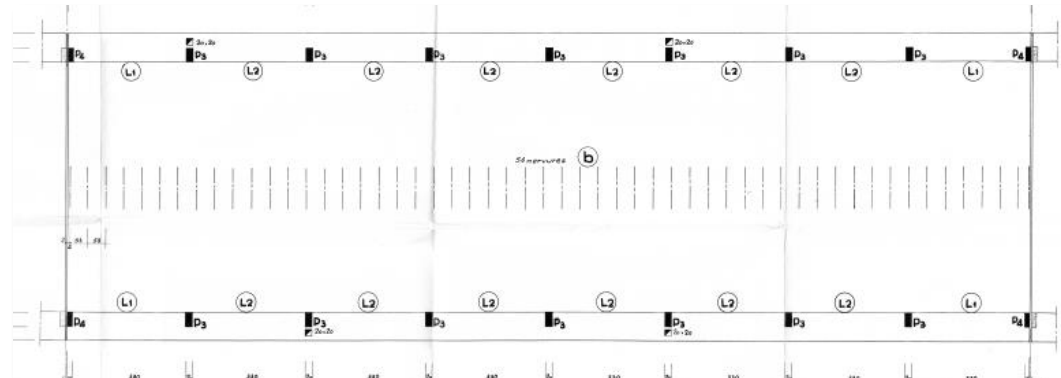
Vue en plan terrasse bloc 2, extrait BA133
